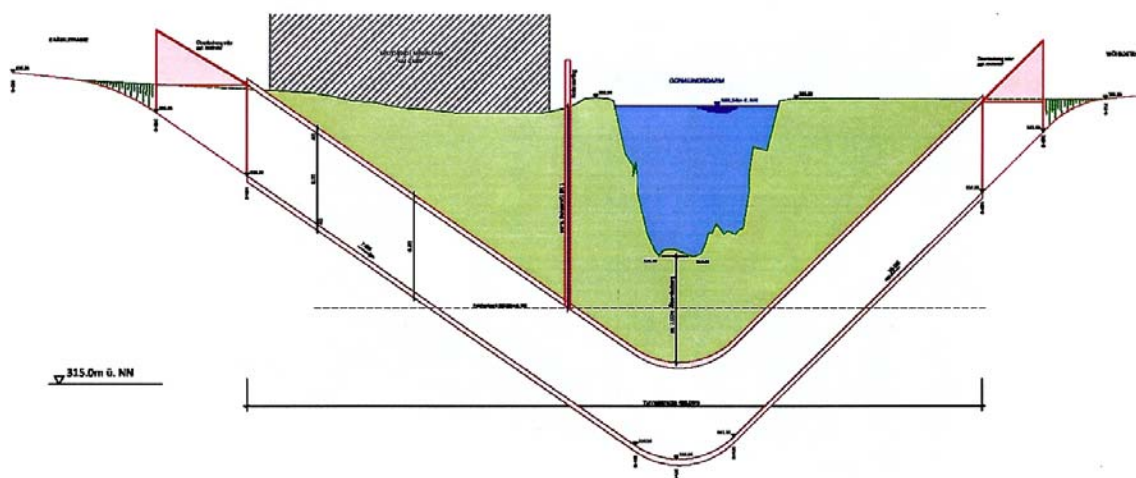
Höhenplan des geplanten Bustunnels (Quelle: Machbarkeitsstudie)
